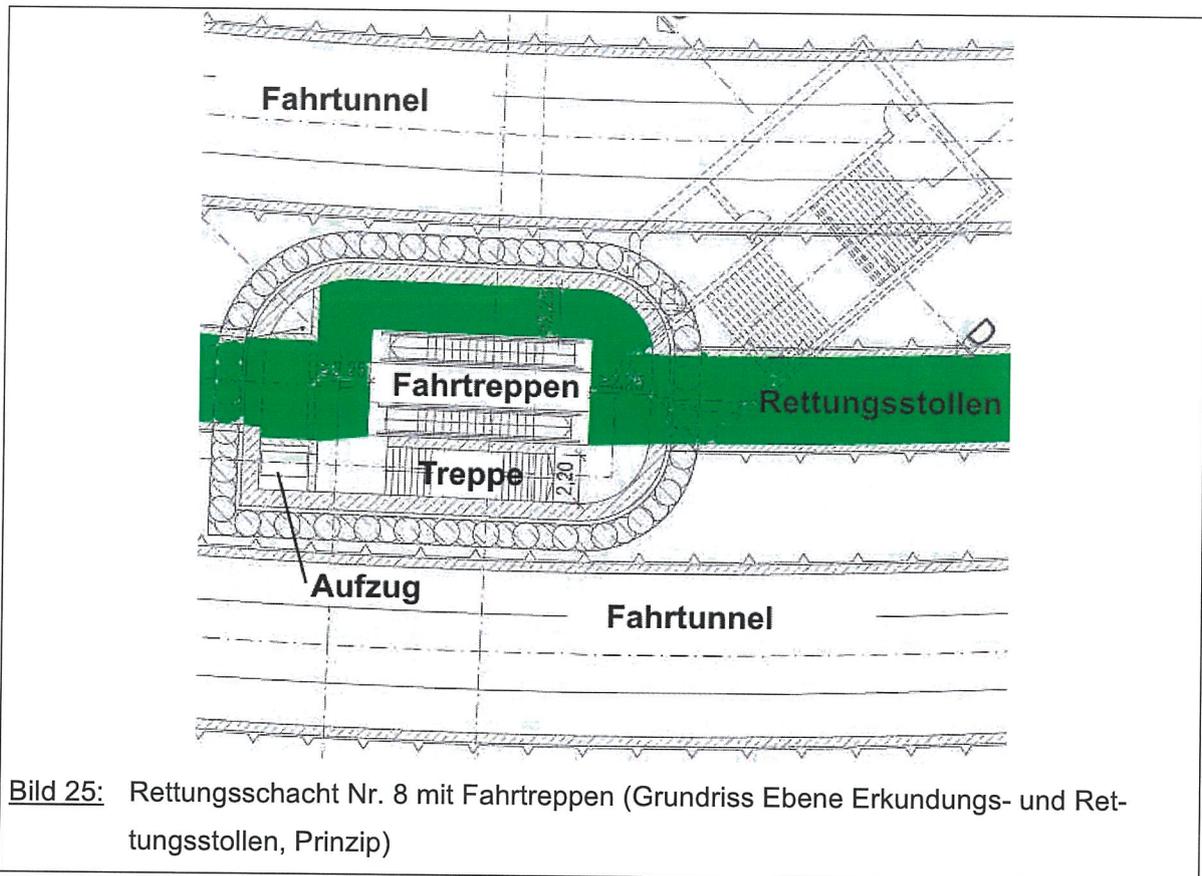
Rettungsschacht Nr. 8 mit Fahrtreppen (Grundriss Ebene Erkundungs- und Rettungsschacht, Prinzip)
